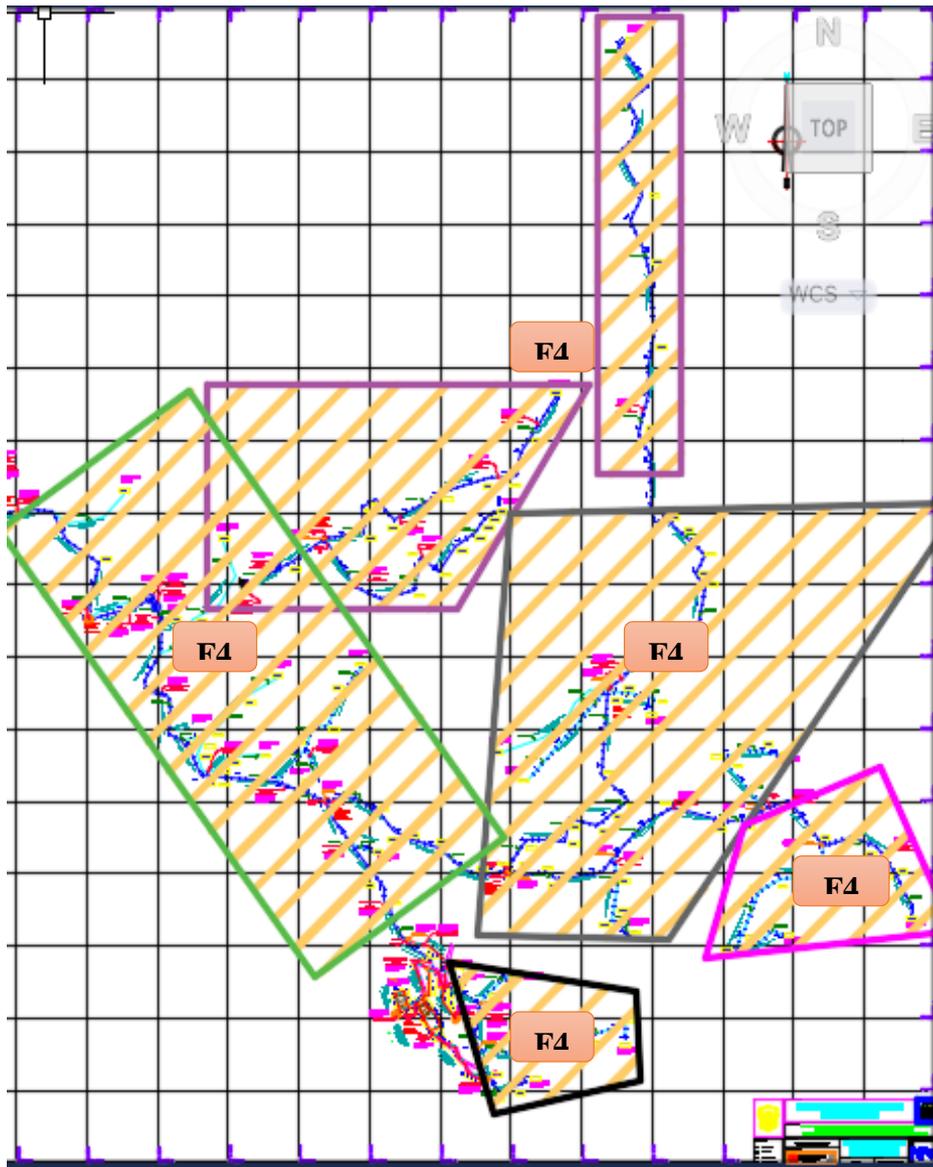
Plano de Planta General sector S1, S2, S3.
